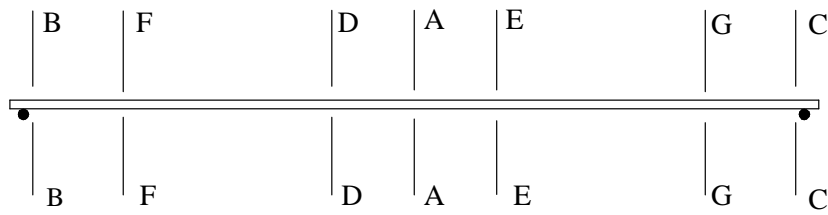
Seções instrumentadas da armadura de flexão do consolo.
